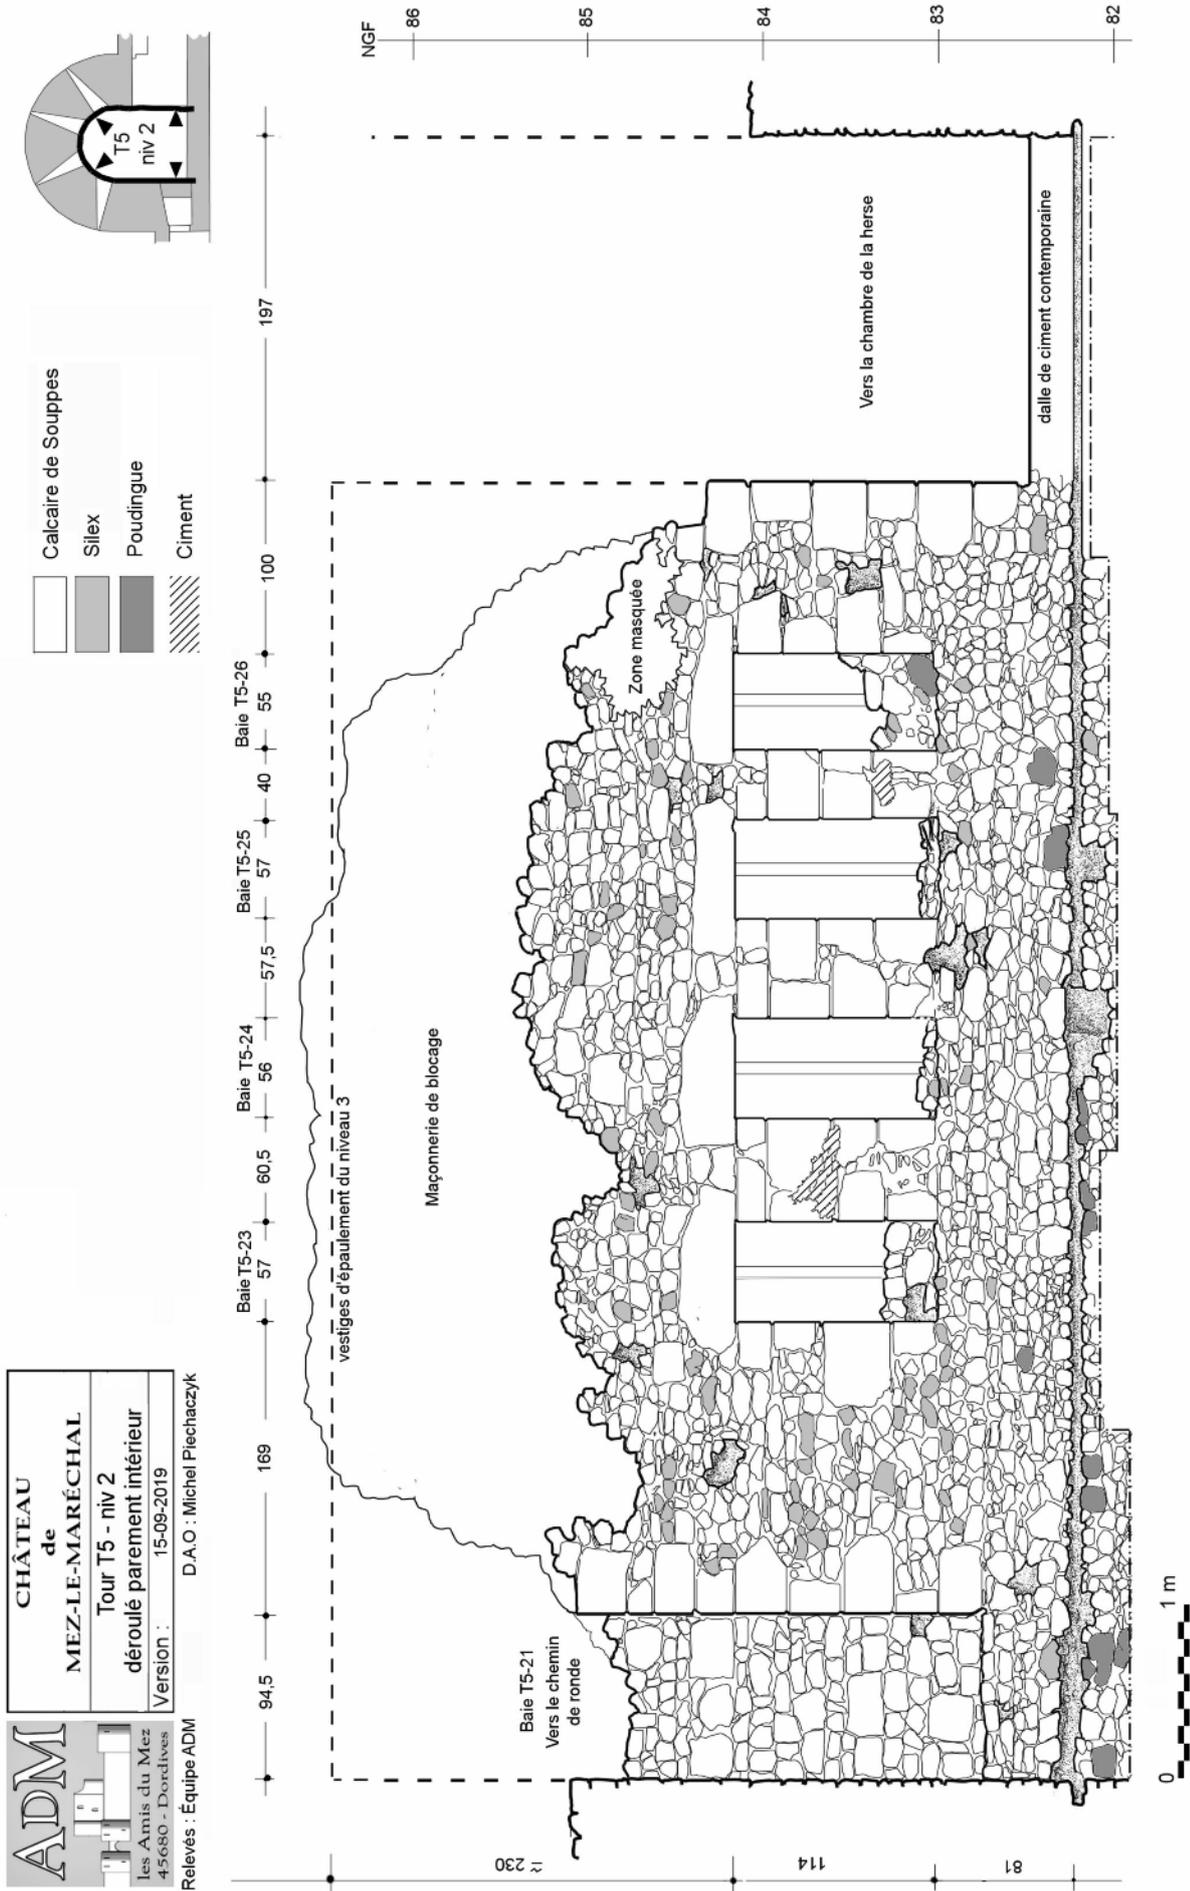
Tour T5 - Niveau 2 - Relevé pierre à pierre du parement intérieur déroulé (DAO : Michel Piechaczyk / ADM).
